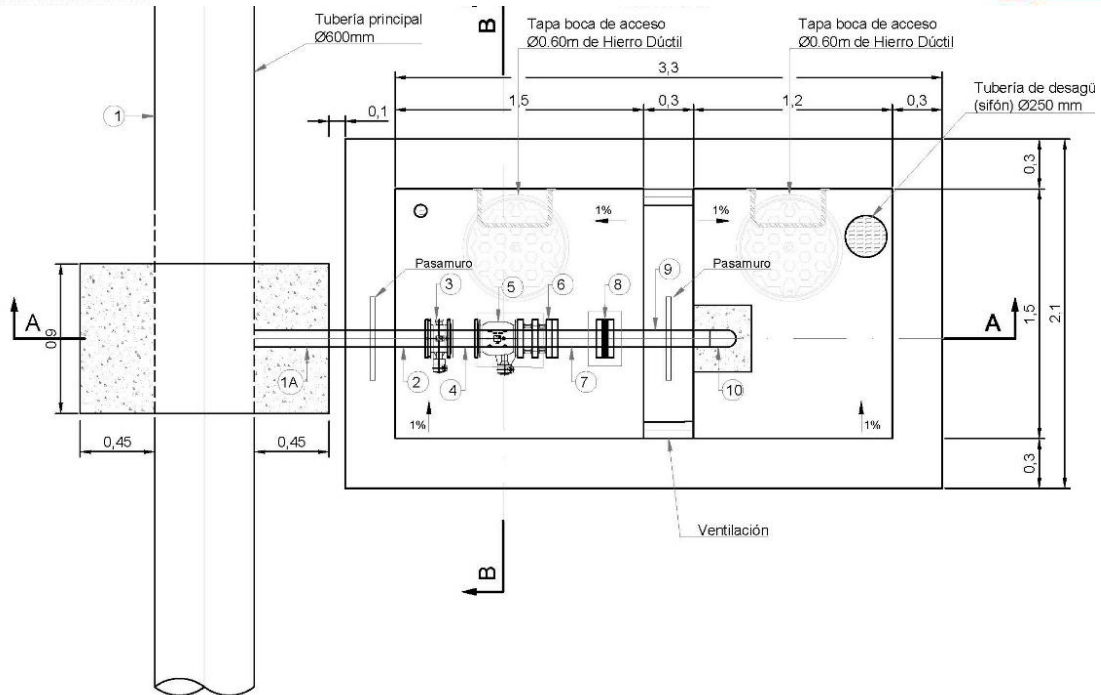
Planta de la cámara tipo para la válvula de desagüe con tubería de descarga
